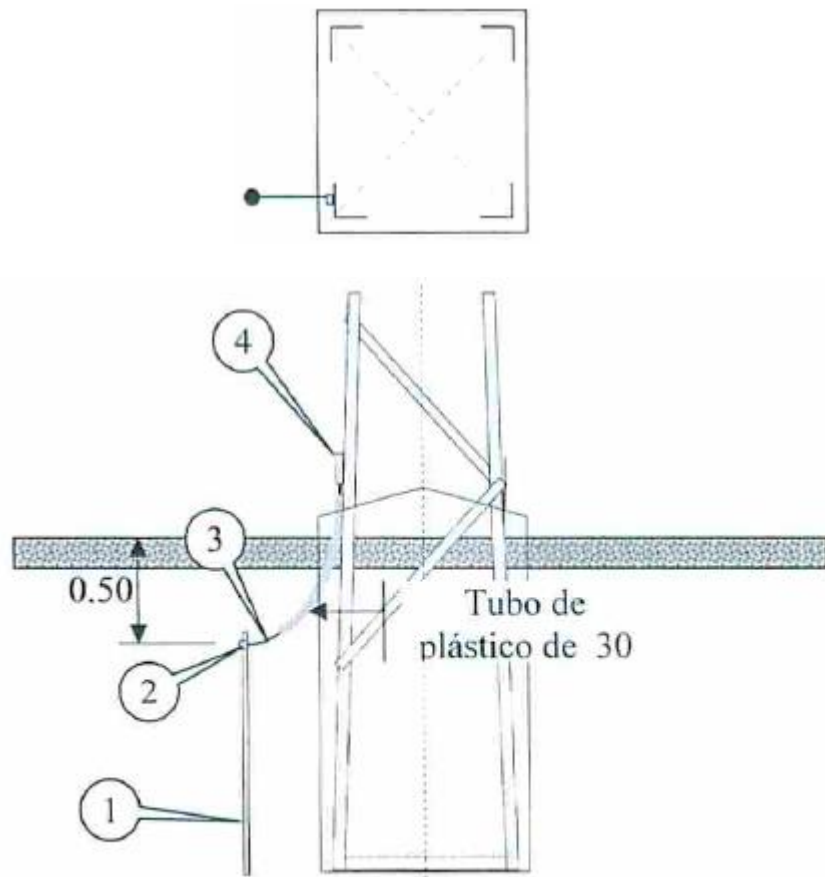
Plano de situación y montaje de pica de puesta a tierra
